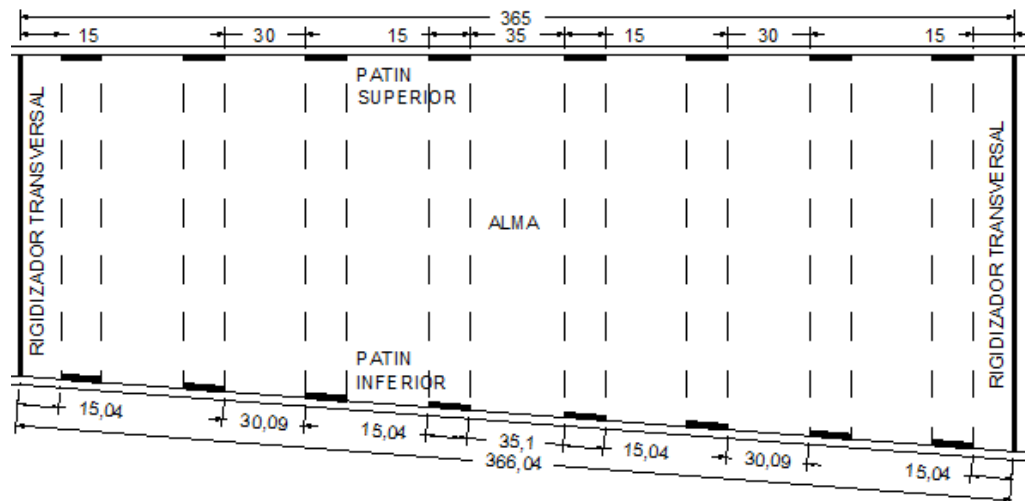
Ubicación del cordón de soldadura patín superior e inferior con el alma de viga (vista lateral)
